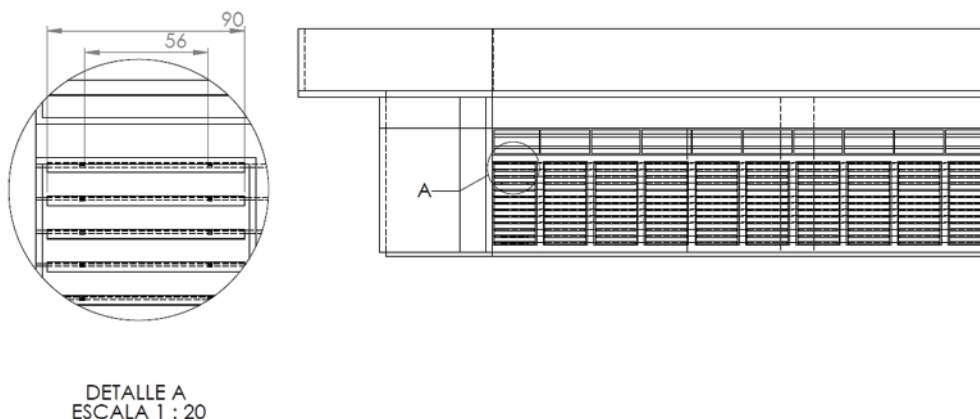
Sistema de cortasoles en Costado Norte y SUR
